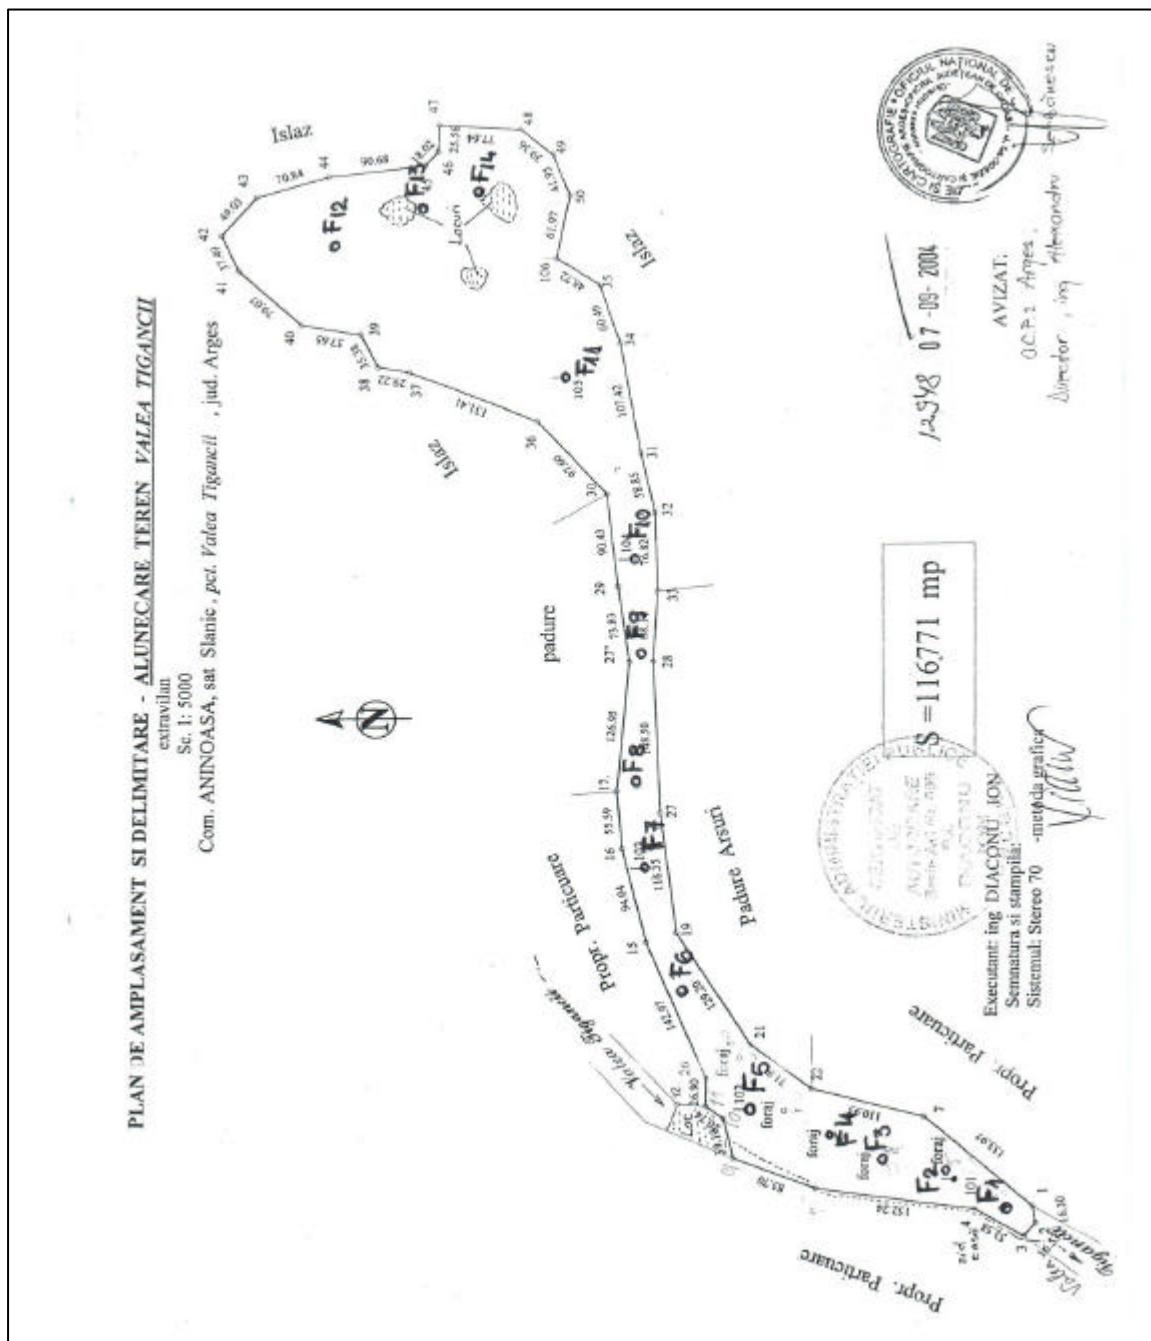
Plan amplasament si delimitarea alunecarii de teren Slanic Nord.
